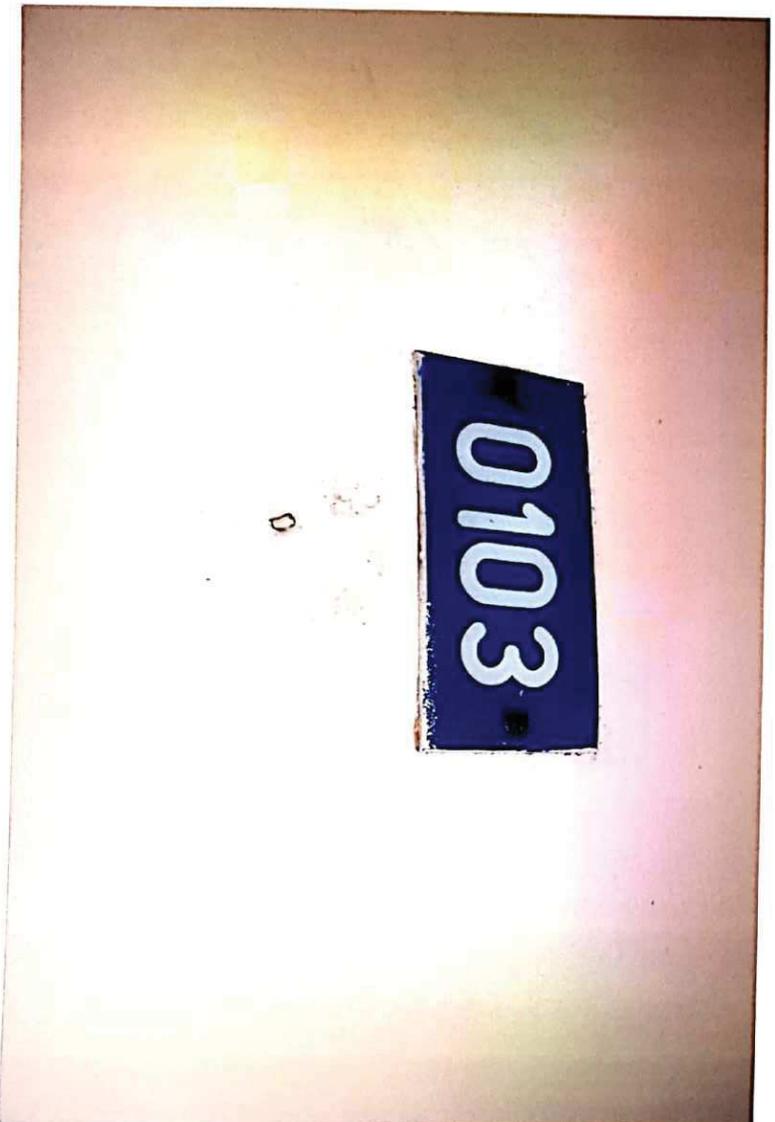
detalhe da porta social de entrada do apartamento nº 103
